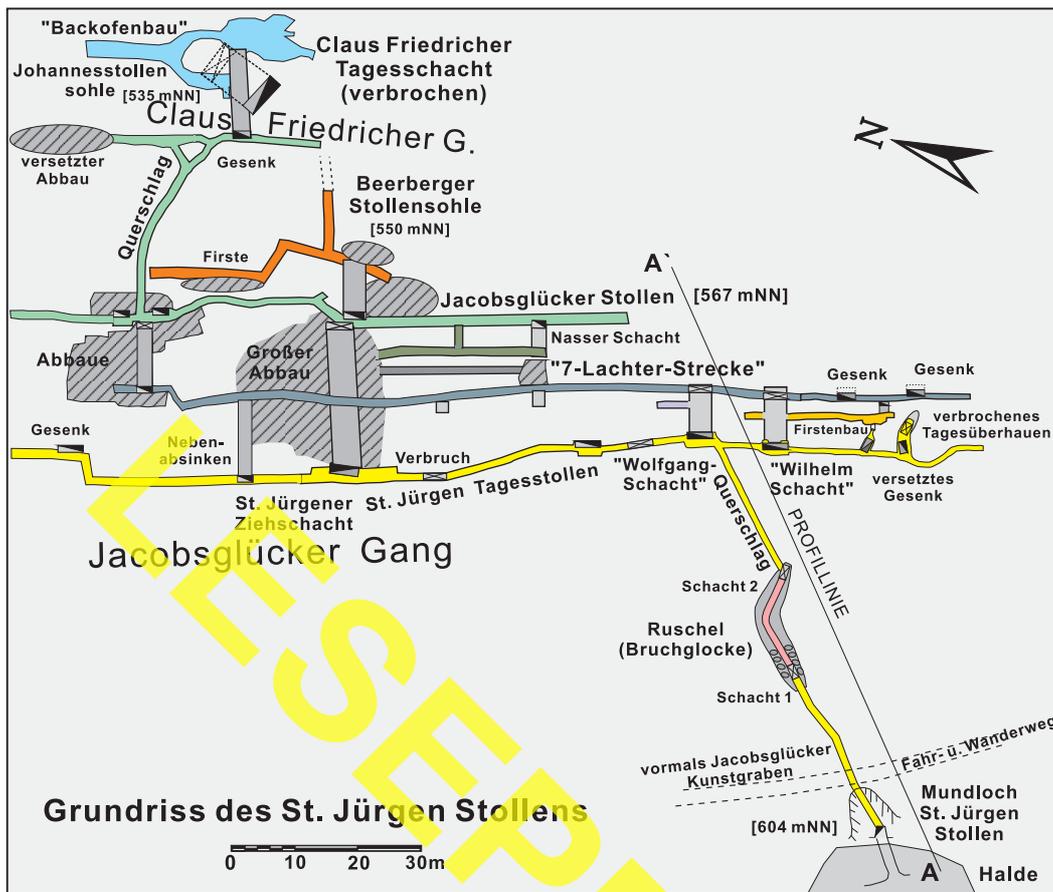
Grundriss des St. Jürgen Stollens und der benachbarten Grubenbaue.
